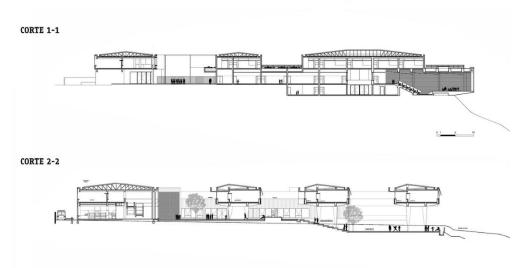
Plano de corte del Liceo Mariano La Torre Fuente: Archidally, 2014
